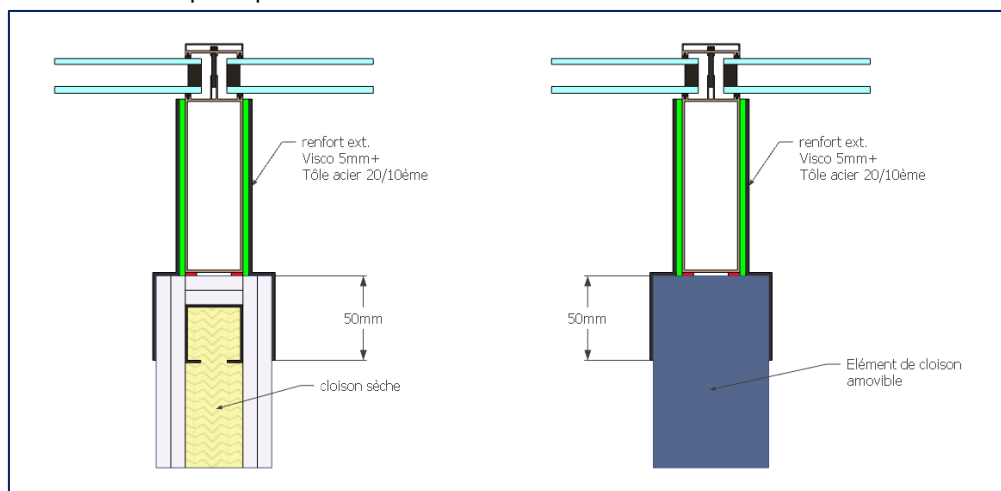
Principe de renfort des jonctions sur montant de façade (hors échelle) - flasquage
